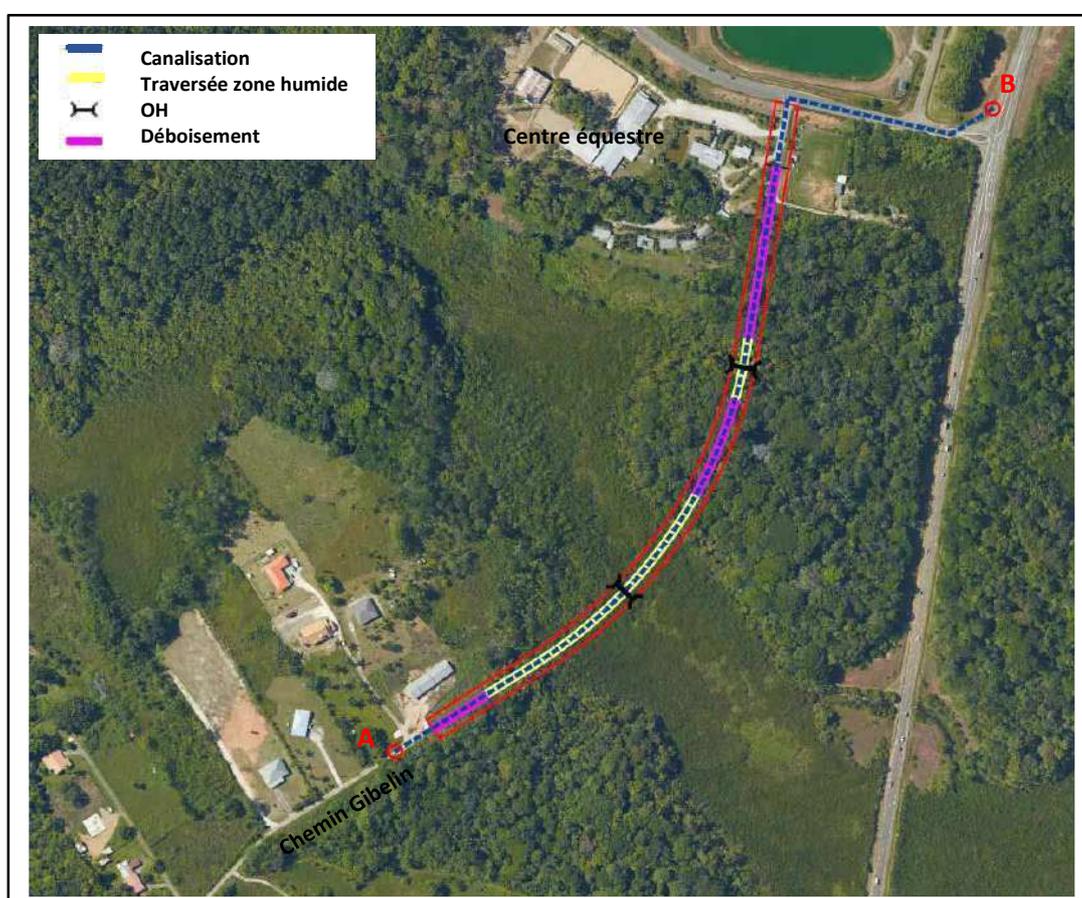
Variante n°1 sur le tracé de la conduite d'adduction
